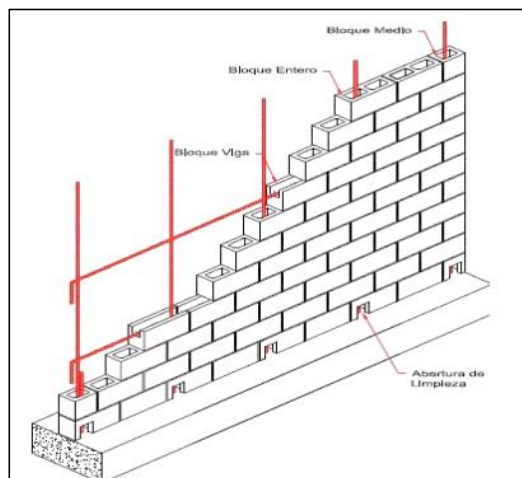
Muro de albañilería armada con su respectivo refuerzo vertical y horizontal.
